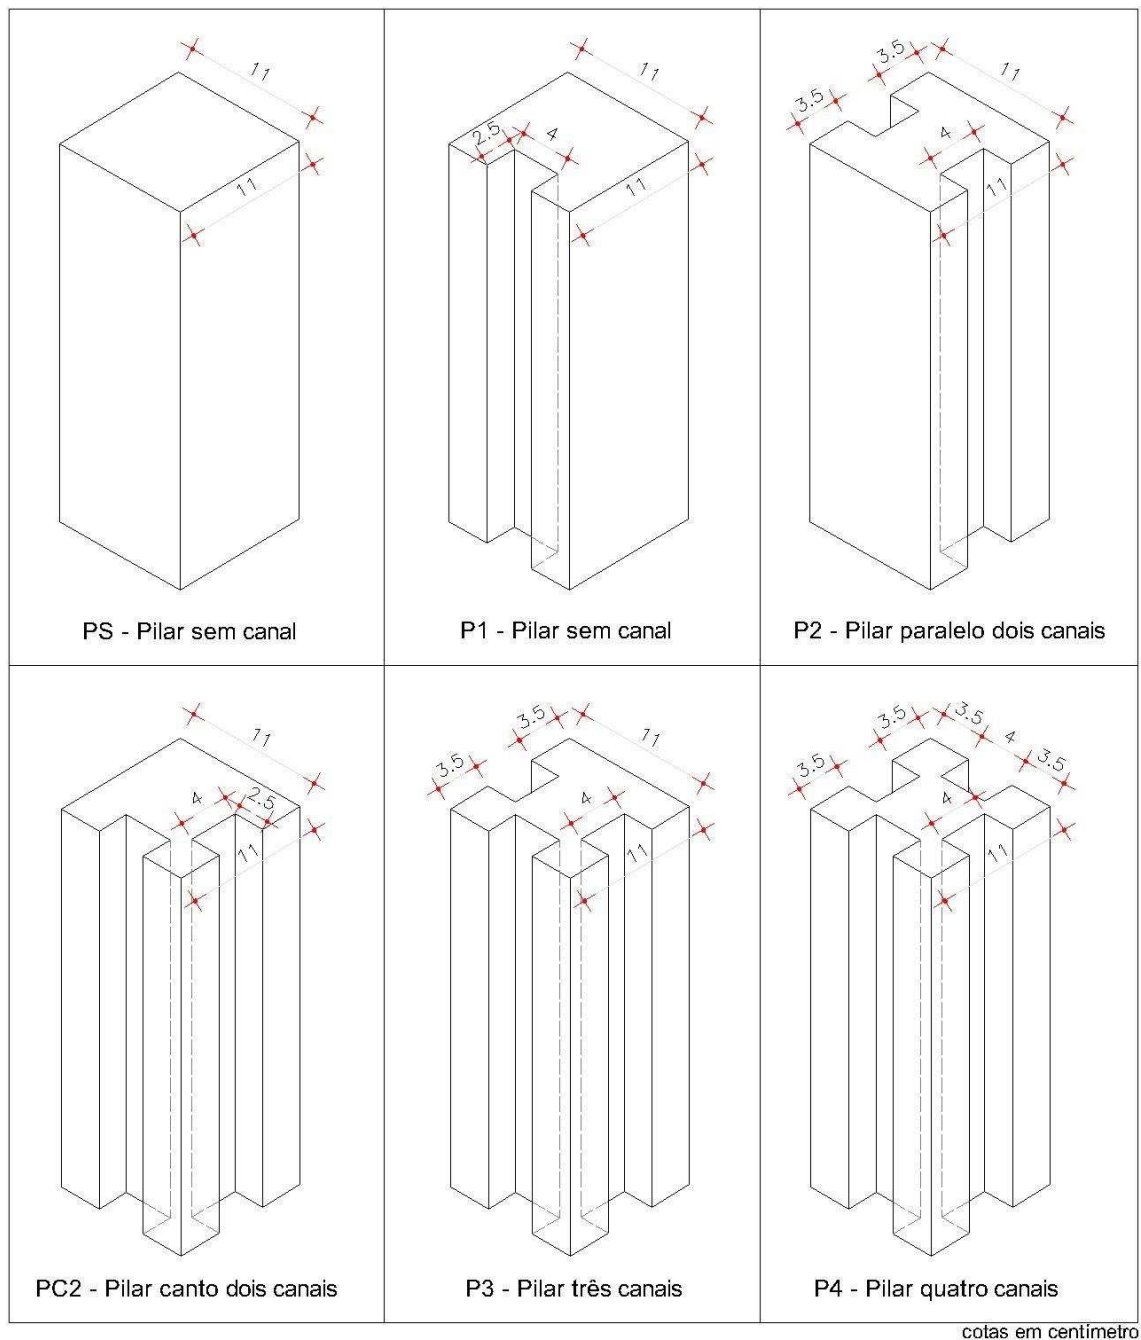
Tipologia pilares e ou montantes para o encaixe das peças de vedação.
